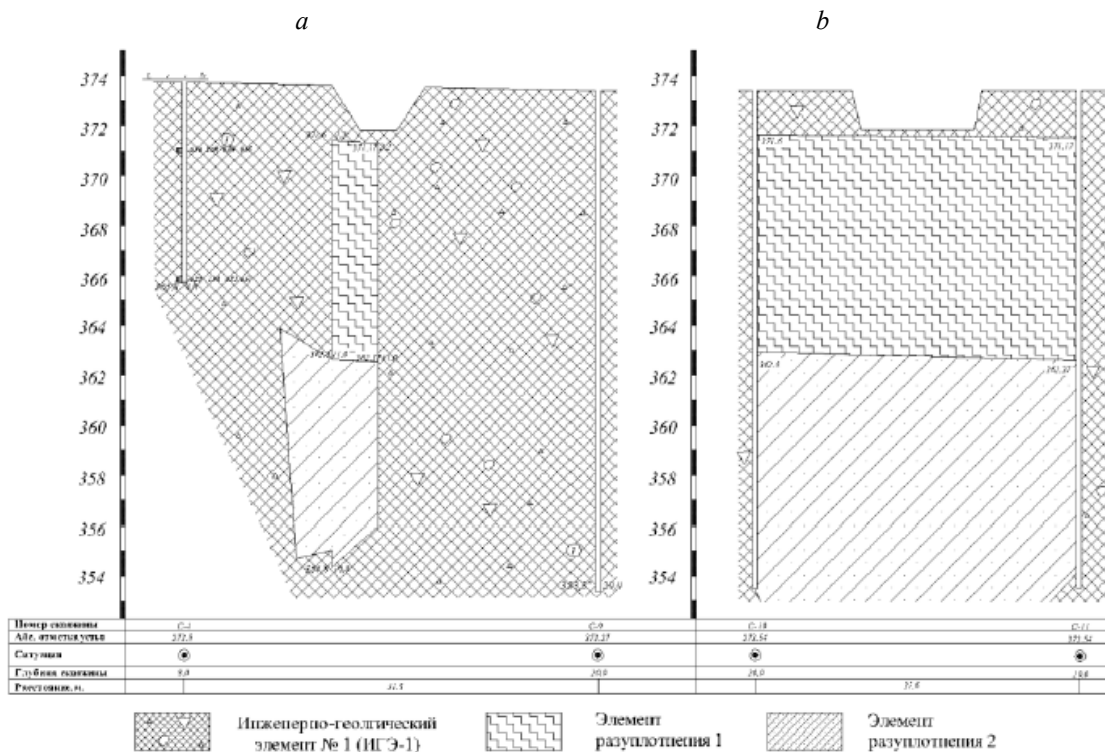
Инженерно-геологический разрез грунтового основания под опорой галереи в продольном (а) и поперечном (б) направлениях
